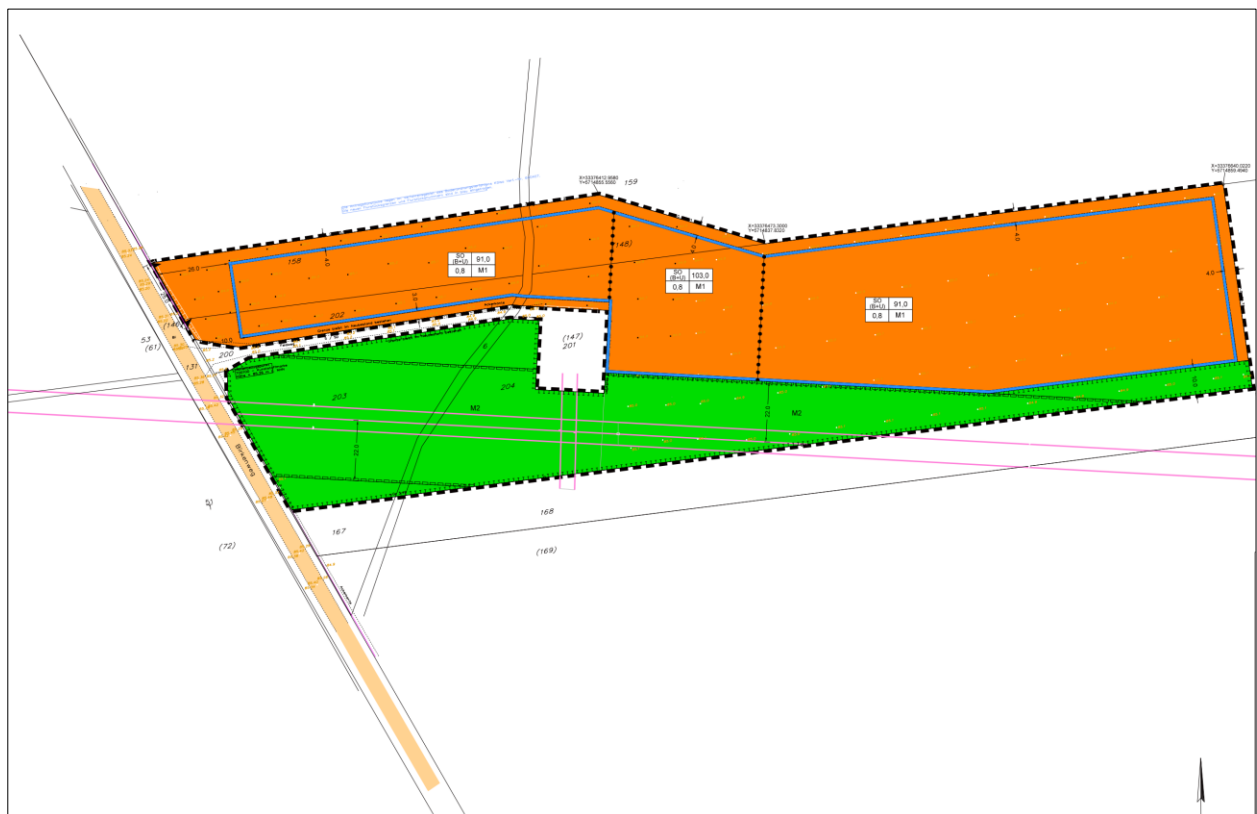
Darstellung Plangebiet Bebauungsplan (© ISP)
